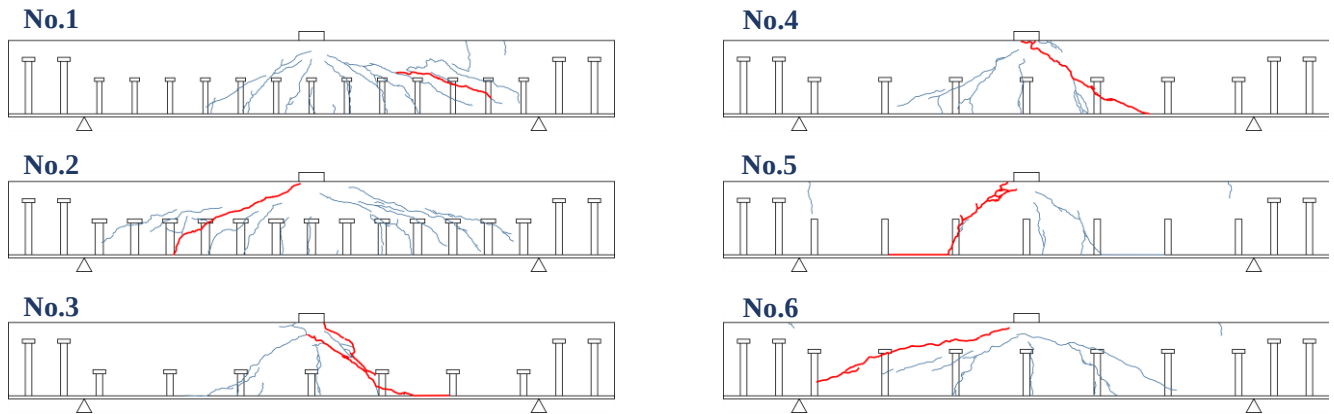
ひび割れ発生状況 (赤太線: 破壊に至ったひび割れ)
